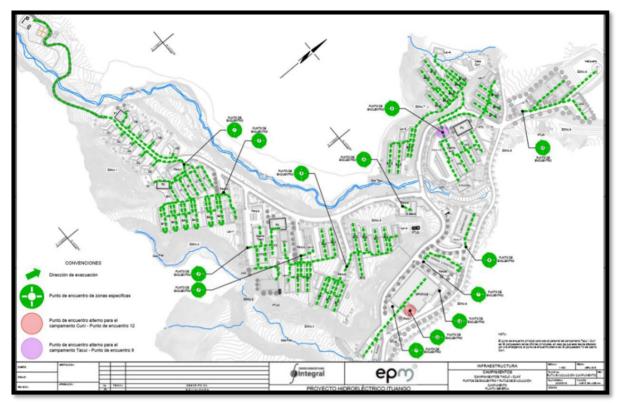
Disposición de edificaciones planta general campamento Tacuí Cuní.
